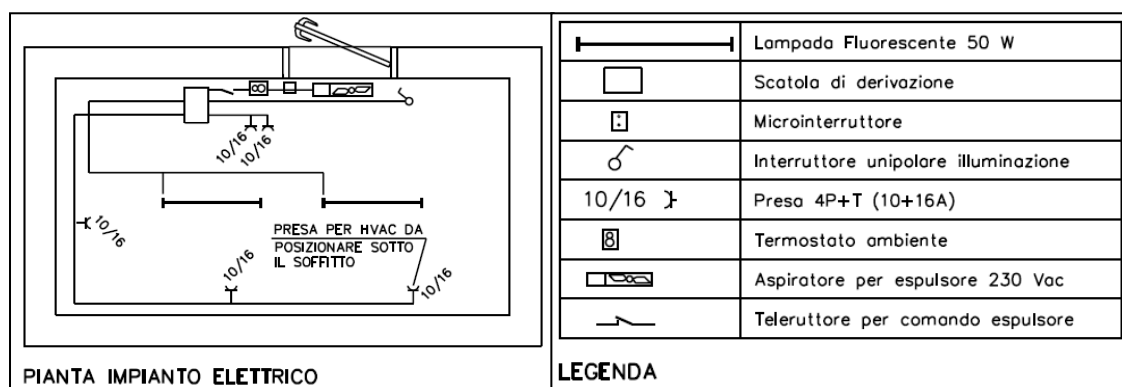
Edificio Tipo B5 – Schema impianto elettrico
